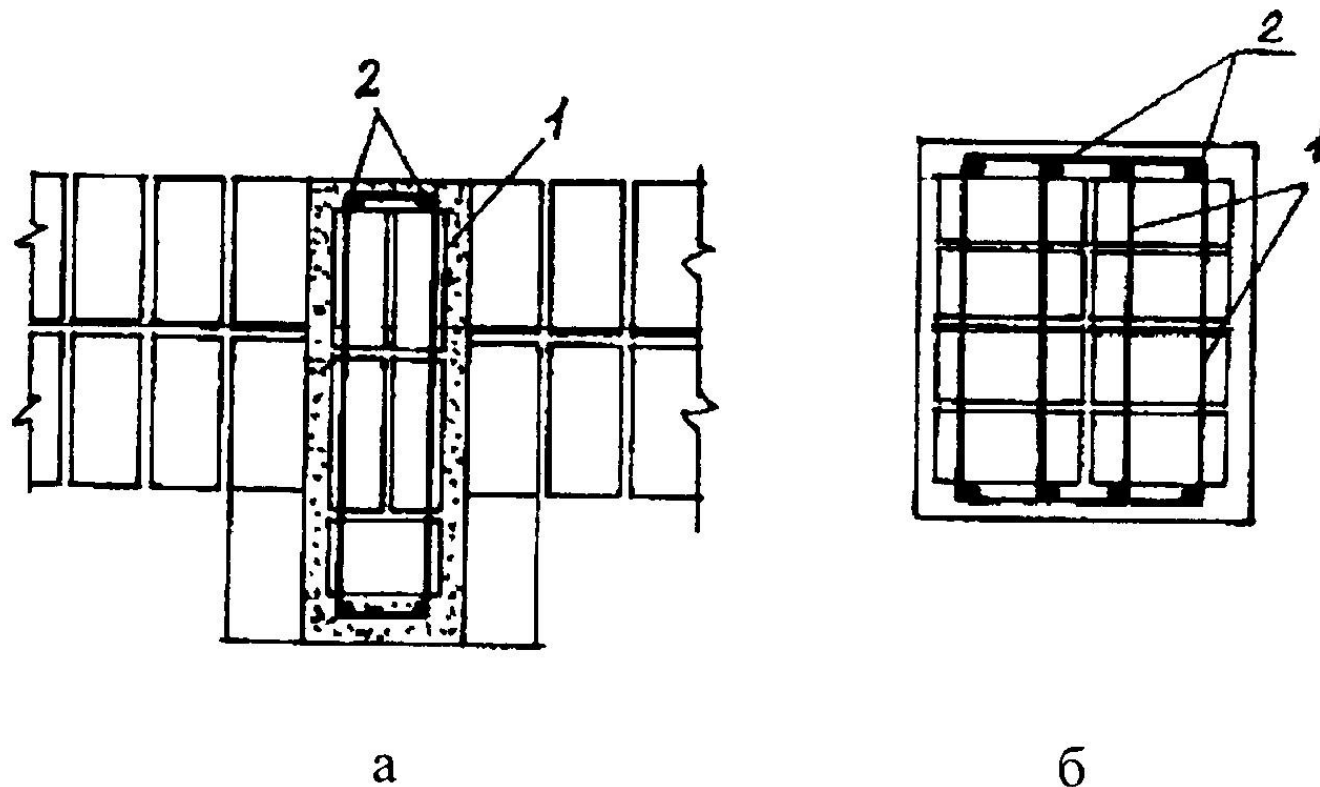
Продольное армирование кирпичных конструкций (стен, столбов и др.):
